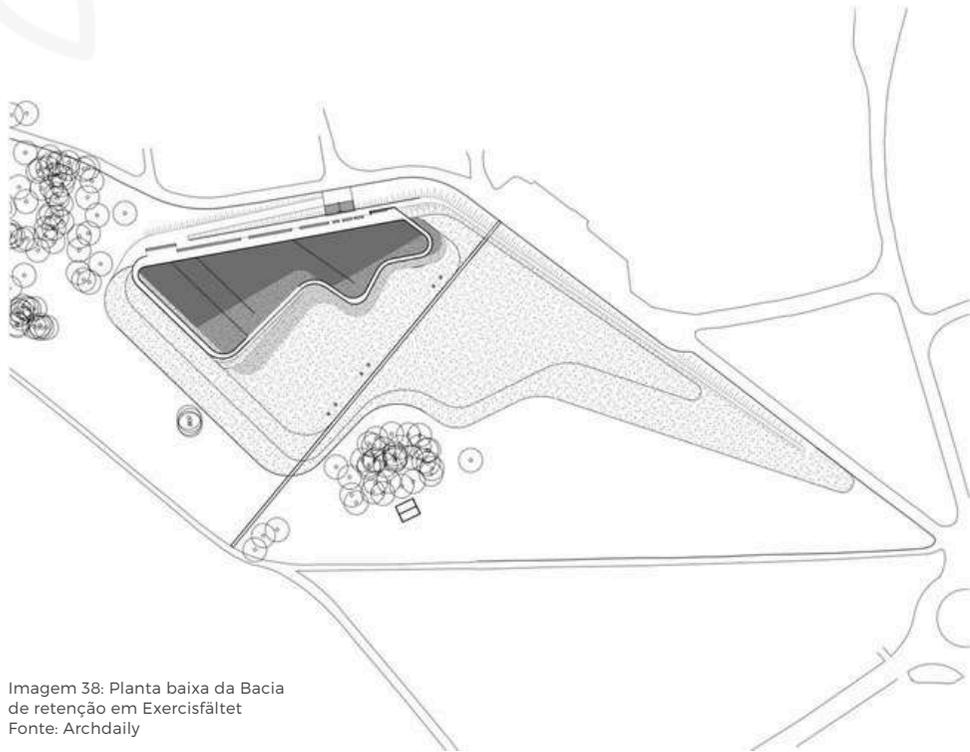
Planta baixa da Bacia de retenção em Exercisfältet
